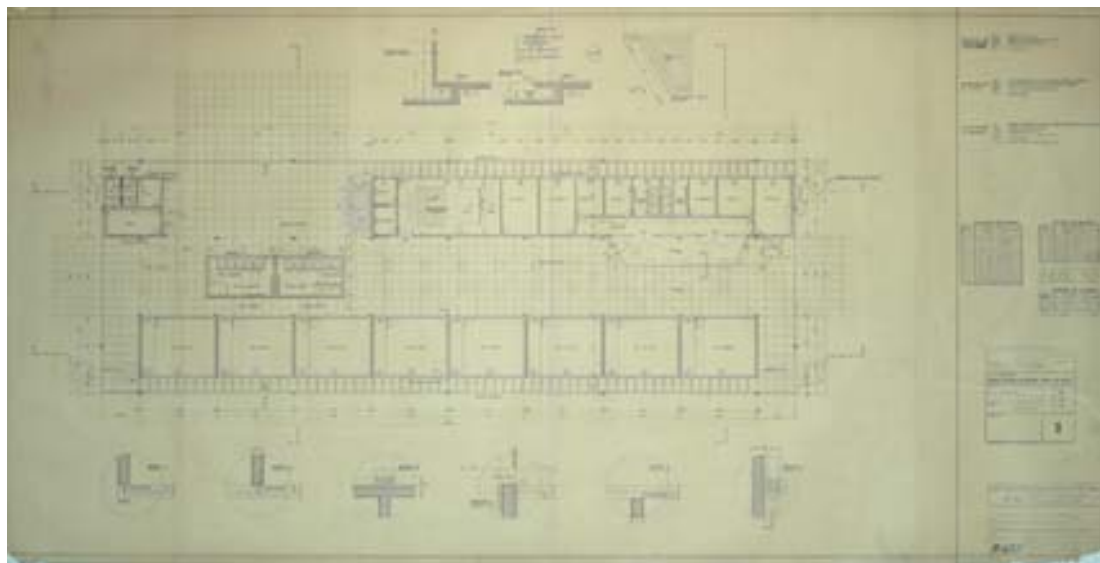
Abrahão Sanovicz, Grupo escolar Bairro Macuco, Santos: planta baixa
